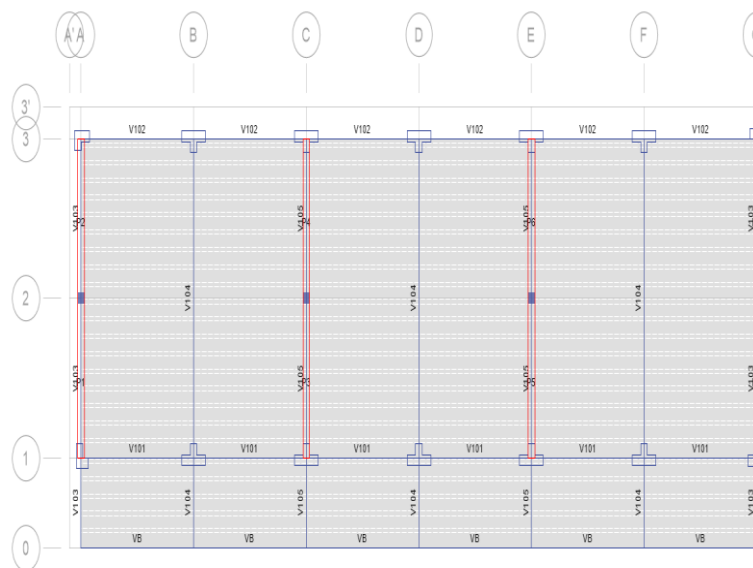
Distribución en planta de elementos estructurales en entepiso
